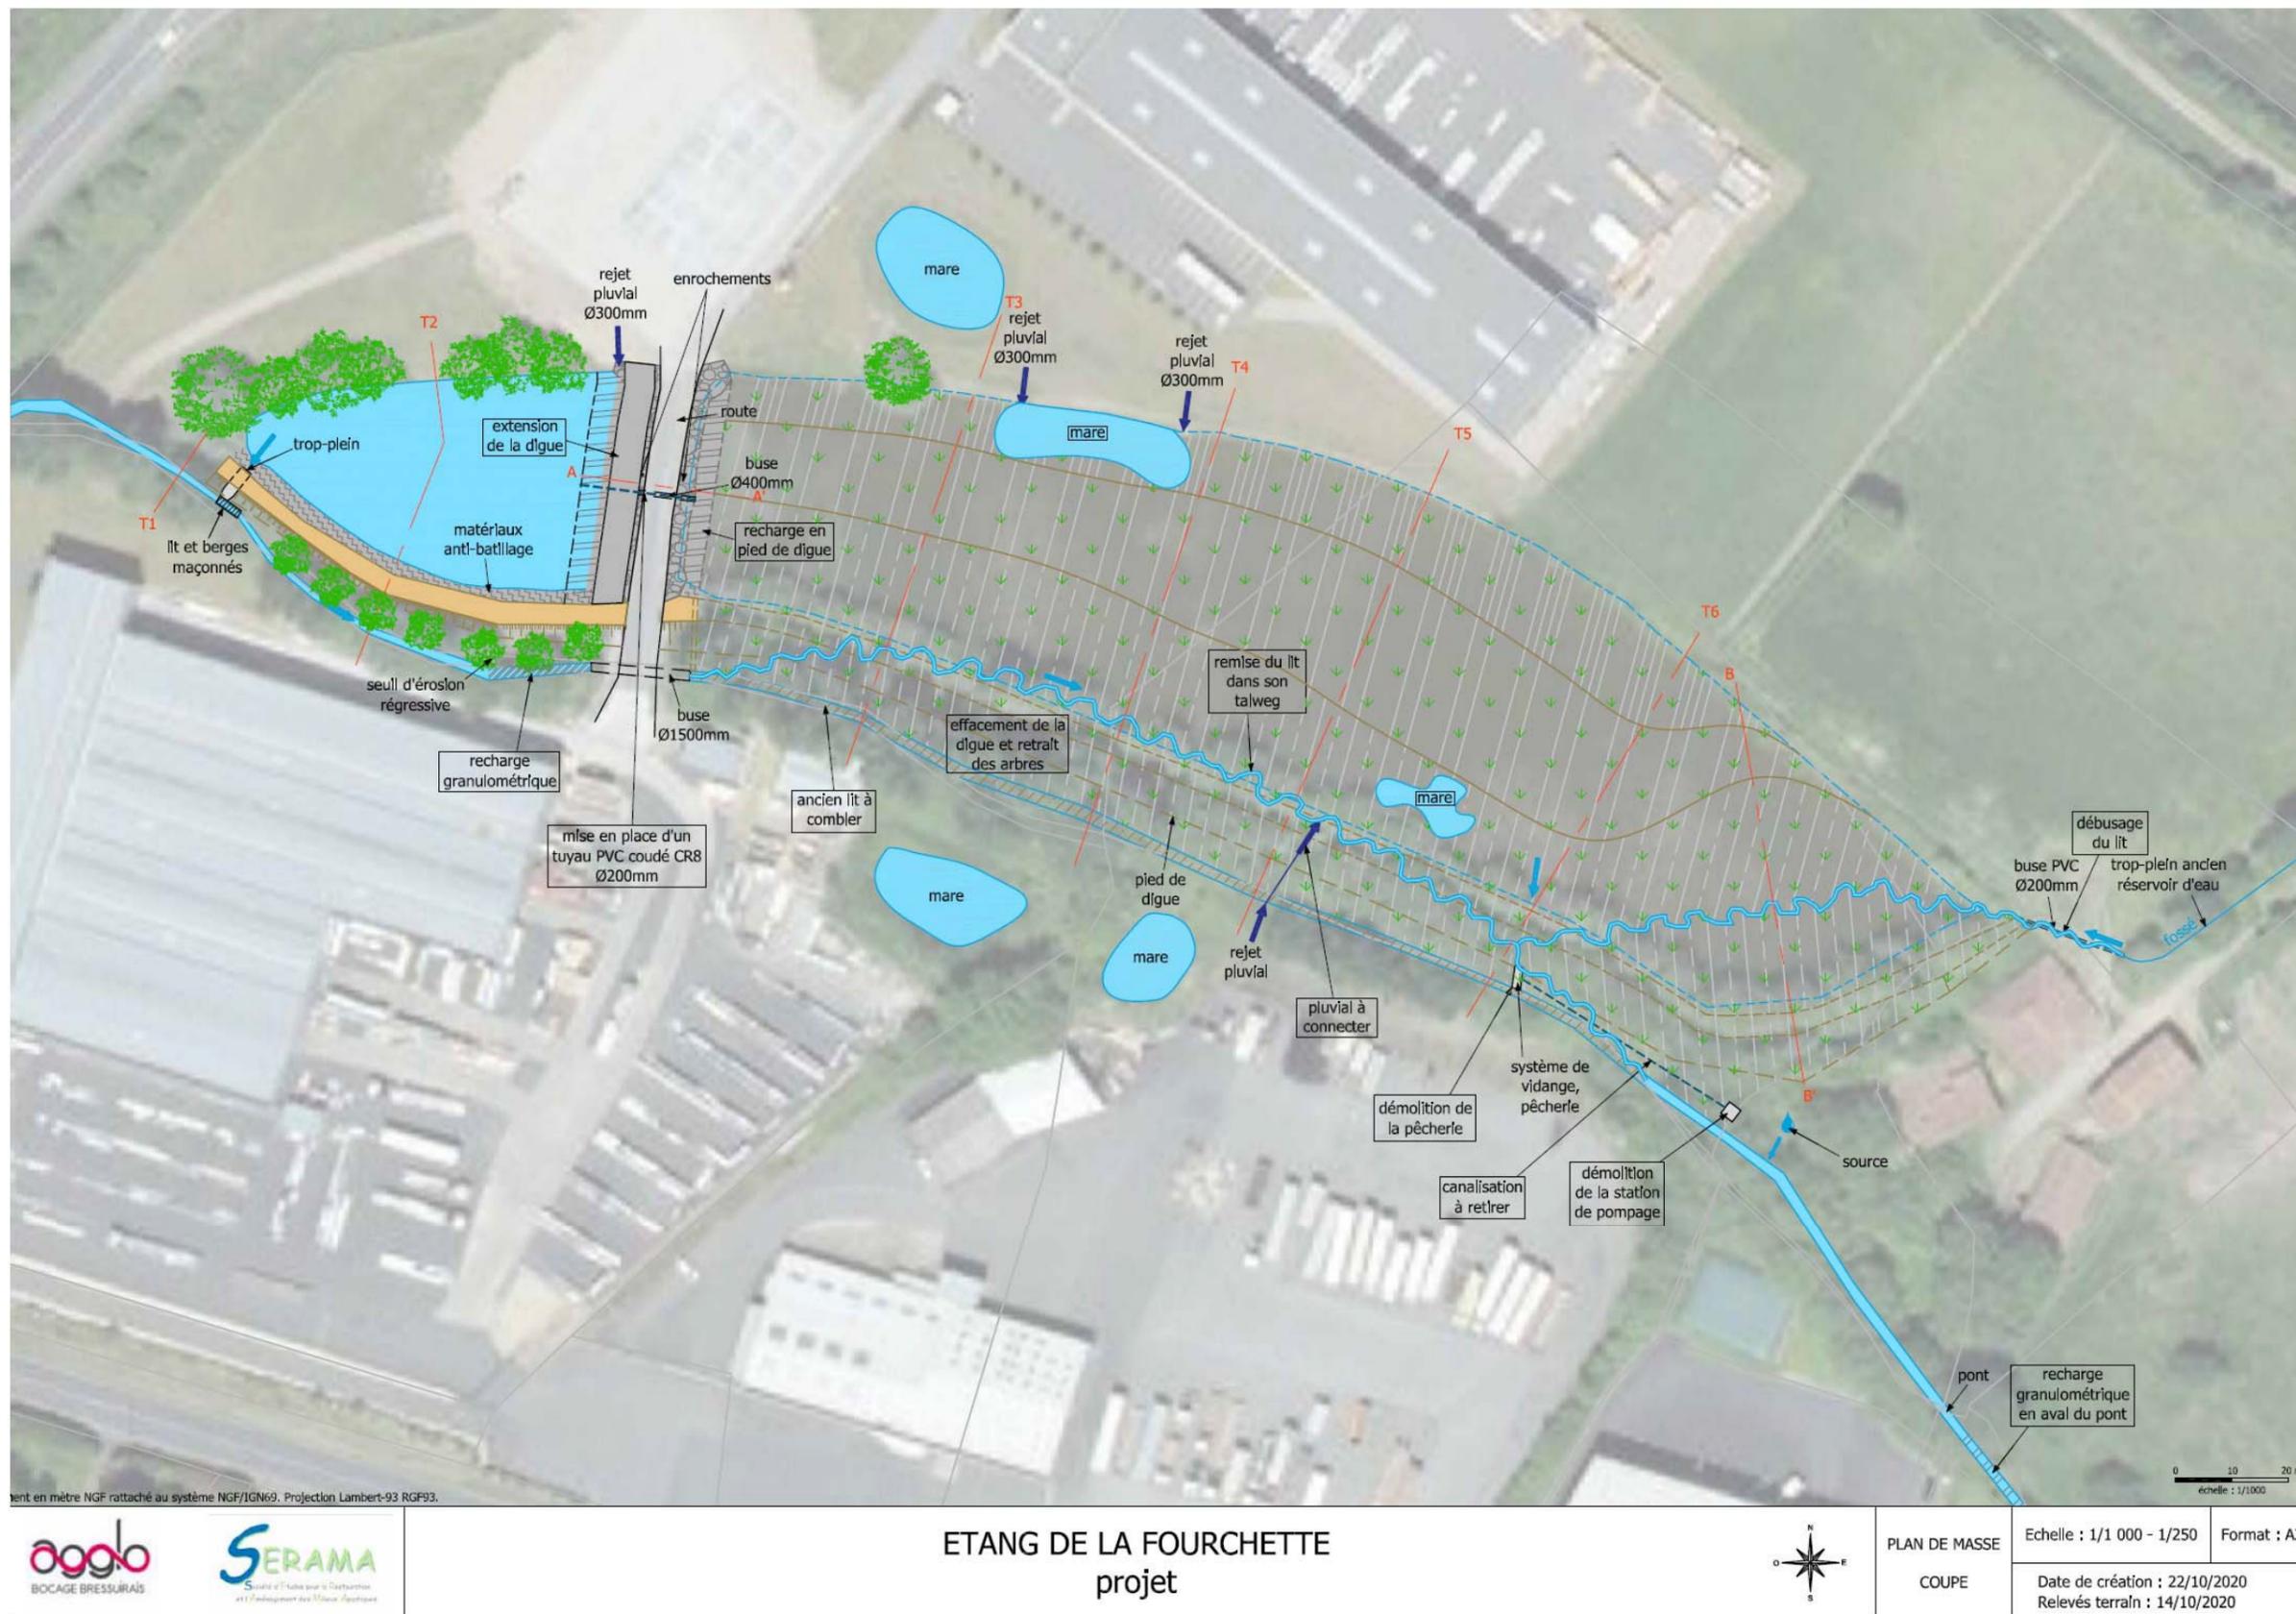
Plan de masse de projet des travaux prévus sur le site du plan d'eau de la Fourchette
